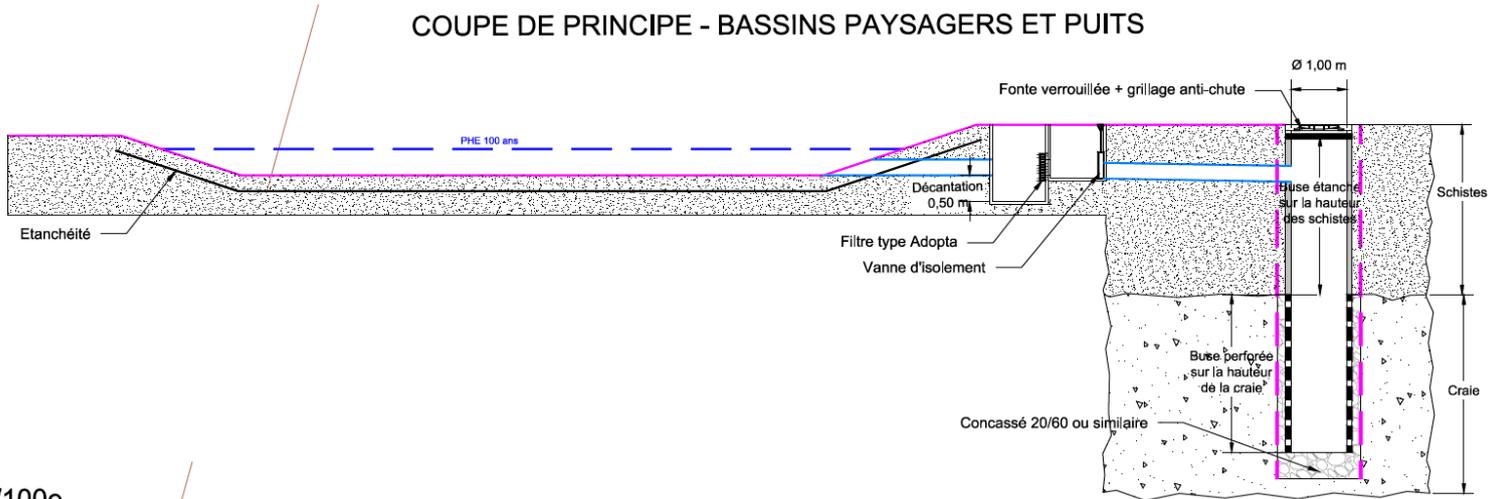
Coupe de principe bassin paysager / puits d'infiltration
